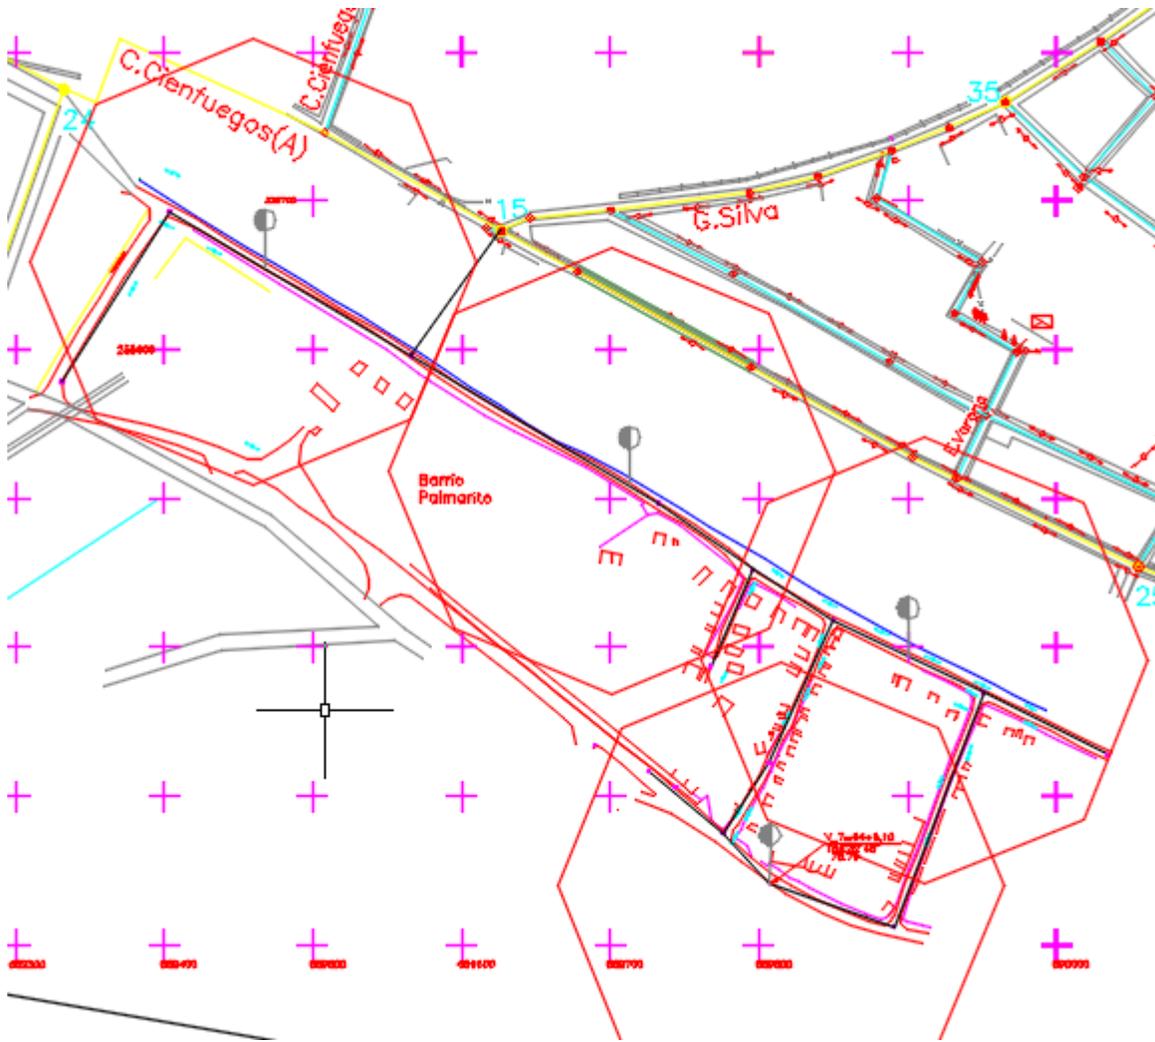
Plano de localización de los hidrantes en el barrio Palmarito
